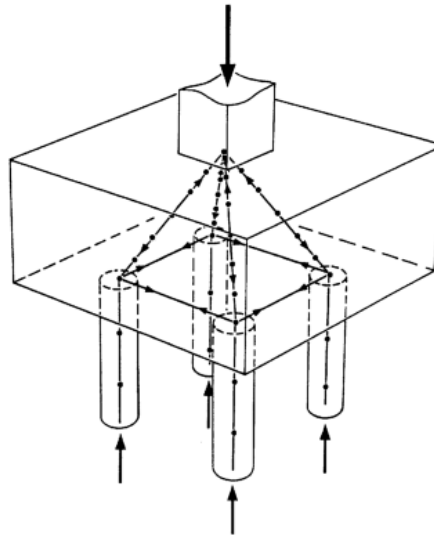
Modelo de BT tridimensional para un encepado de cuatro pilotes (Adebar y Zhou (1996) [6])
